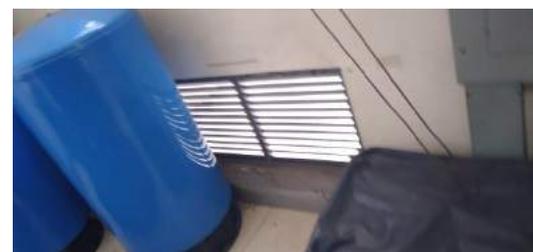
Ventilación planta e. Fuente: fotografía propia, 2020.
